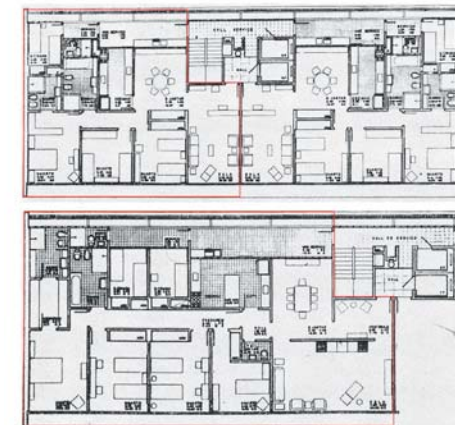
Grundrissvarianten eines Wohnblocks in der SQS 315.
